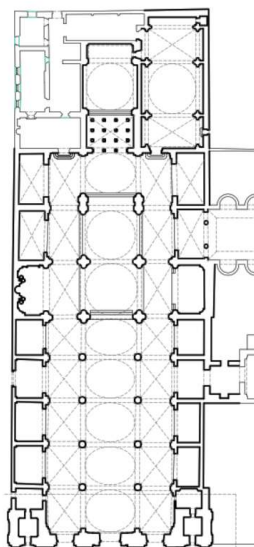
Subdivisión por áreas del levantamiento de la catedral (Autor, 2024).
